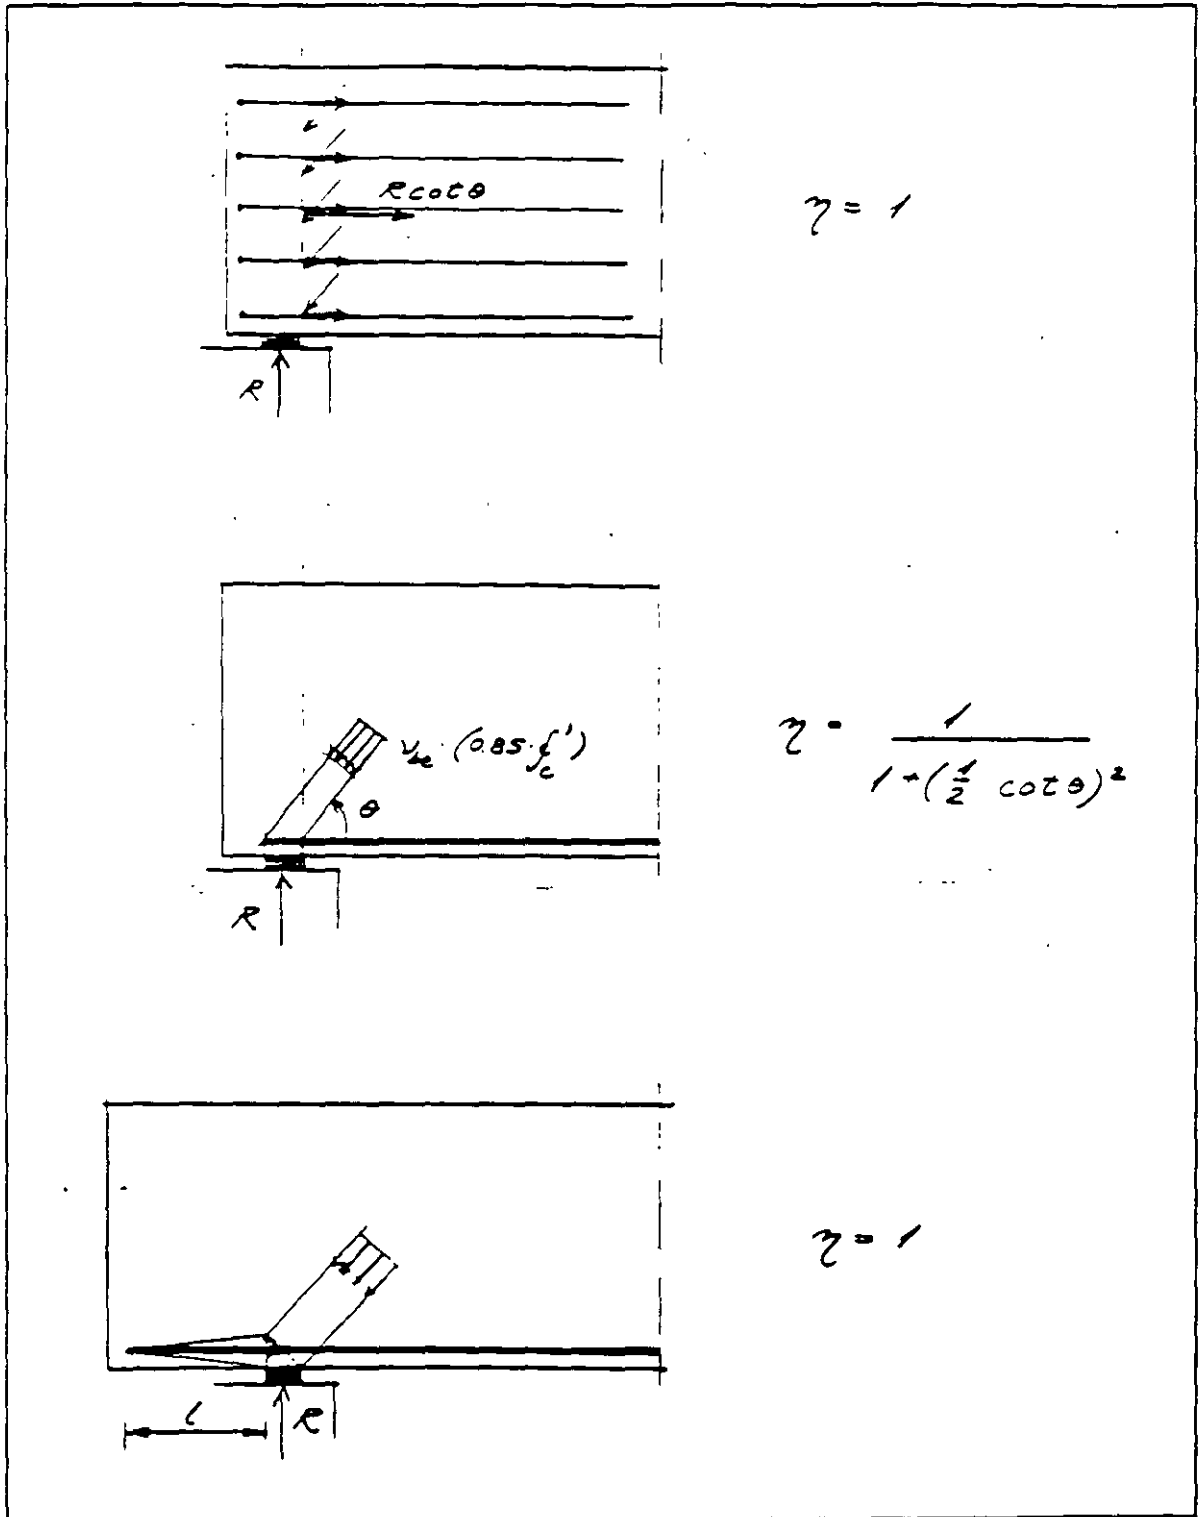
Distribuciones de esfuerzos en la zona de anclaje y apoyo
